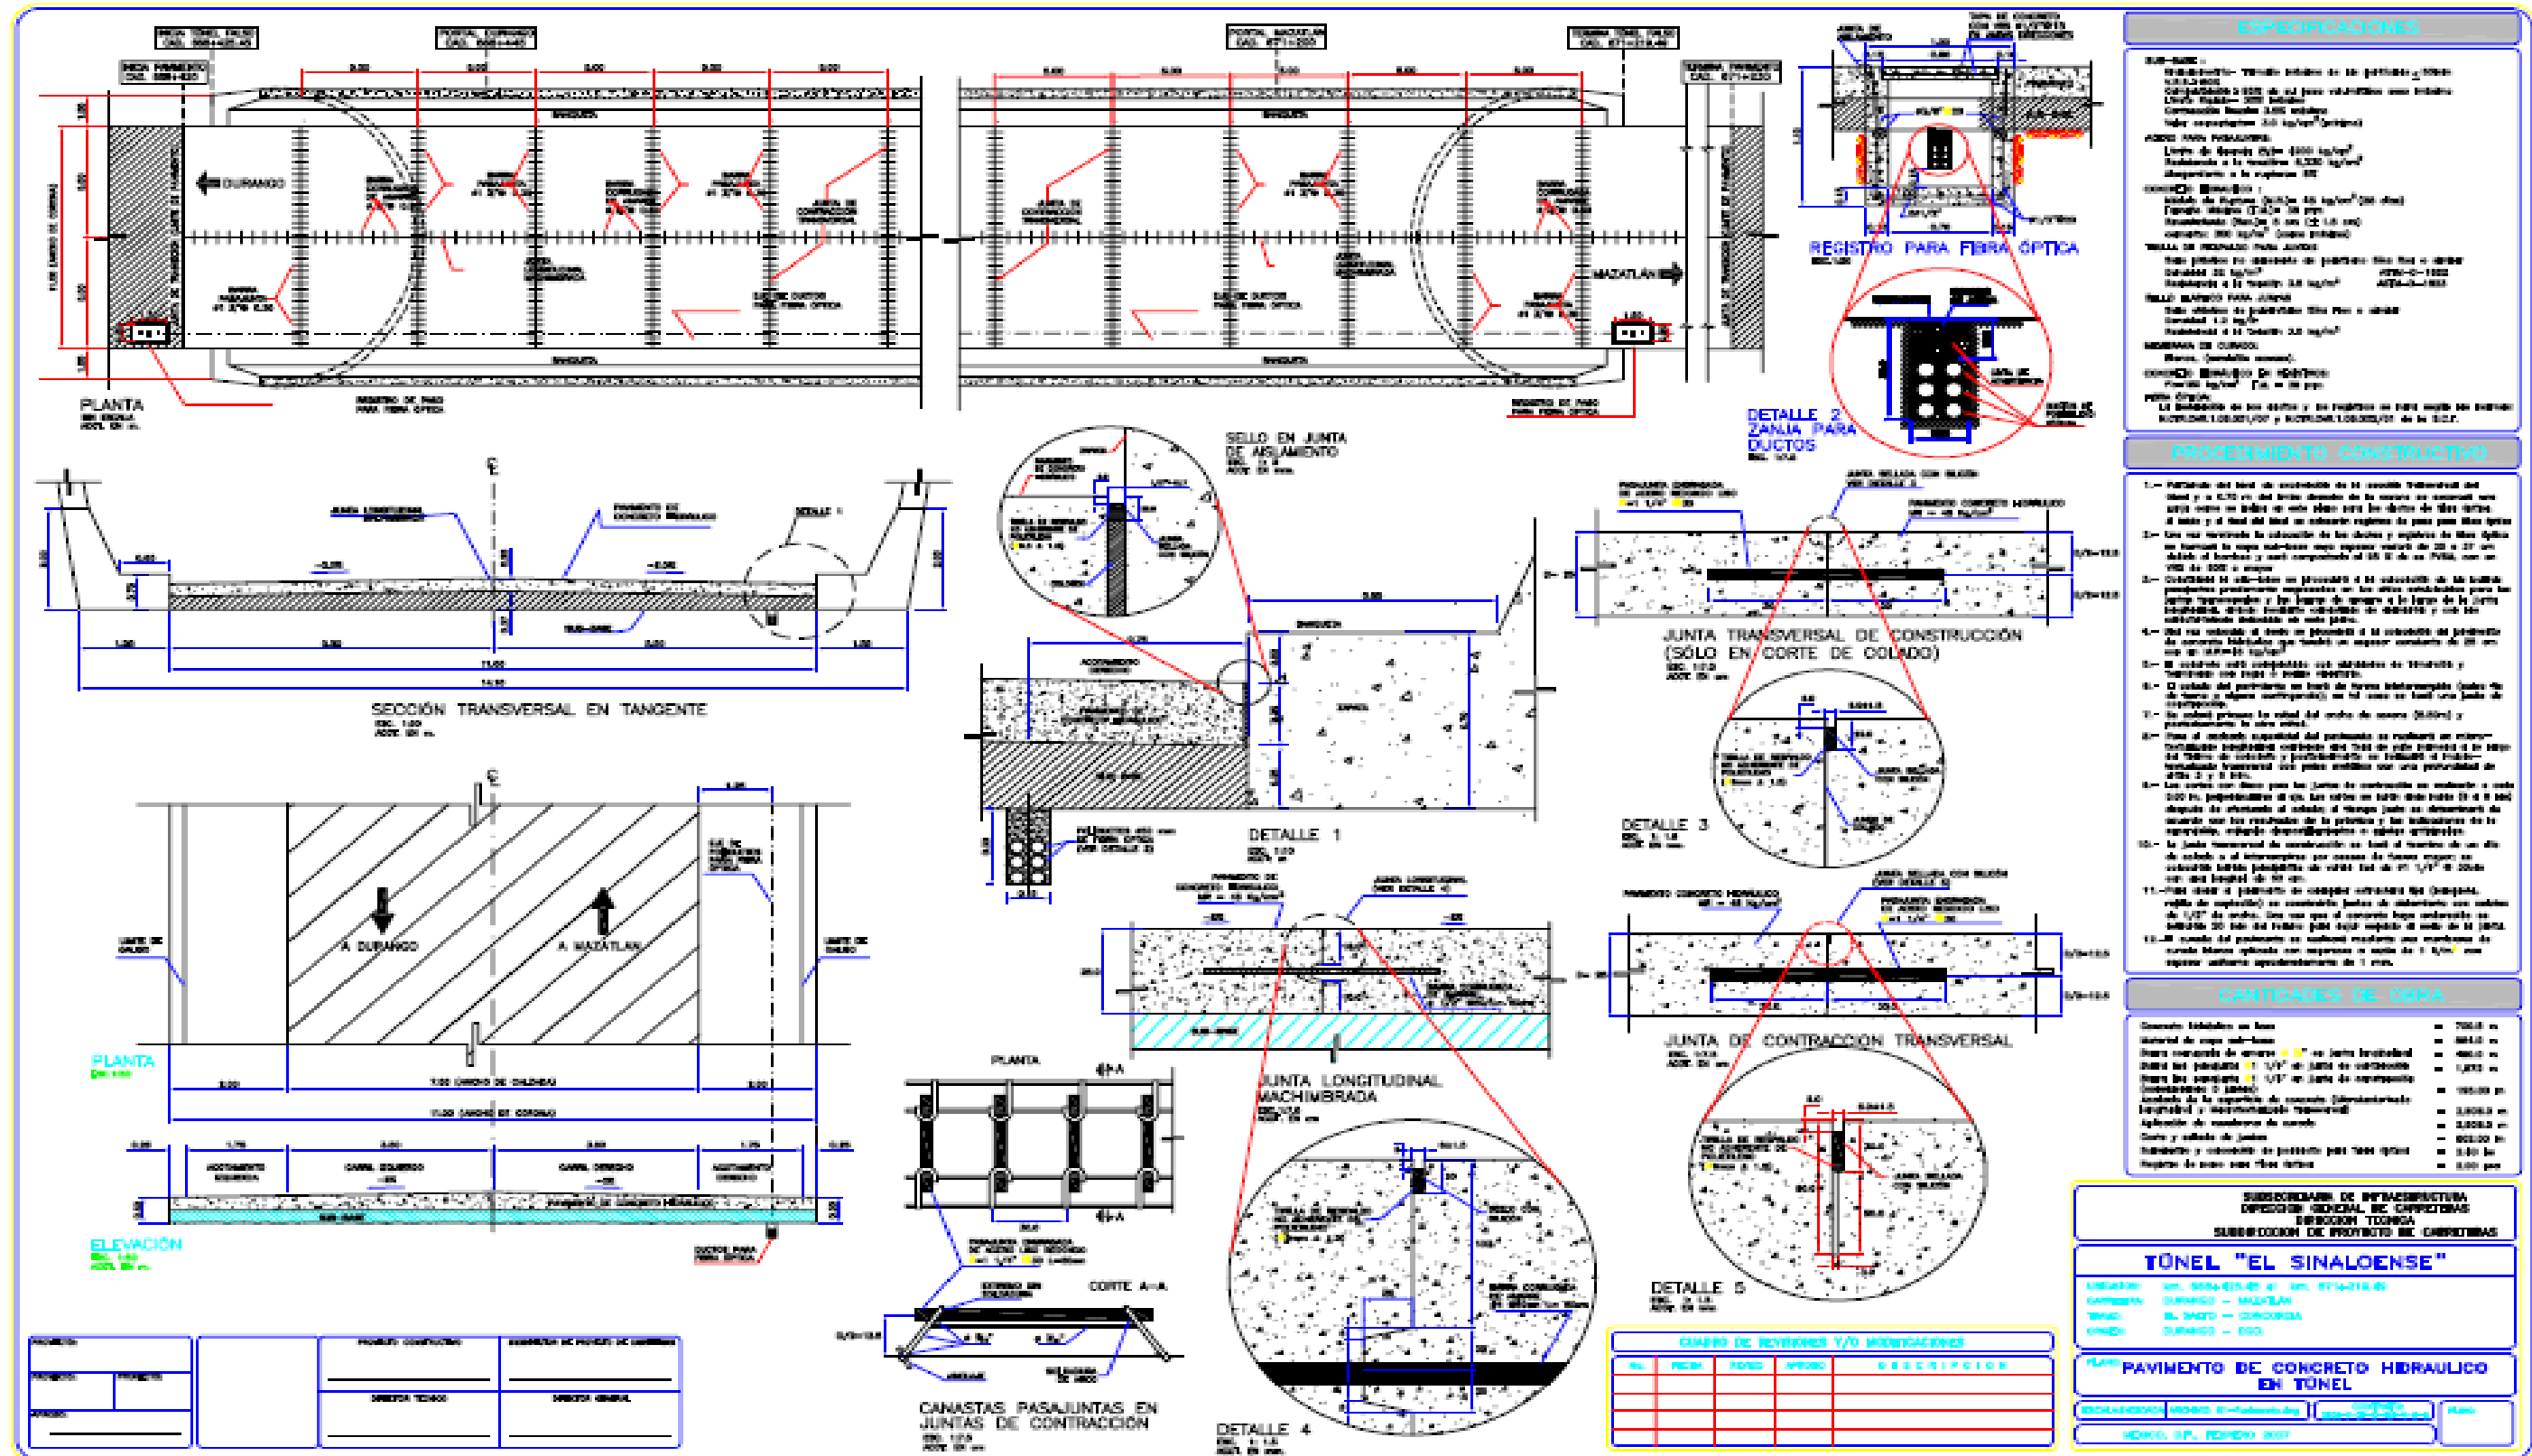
Planos del Pavimento del Túnel Sinaloense
